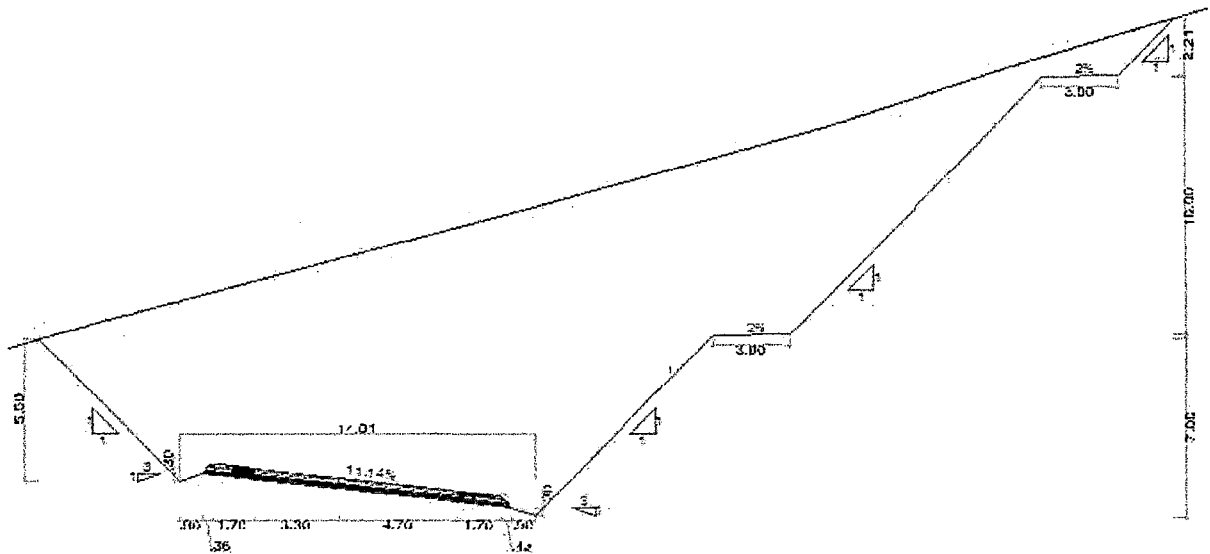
Sección transversal (en corte) en curva con banquetas - Fuente. Elaboración Propia
